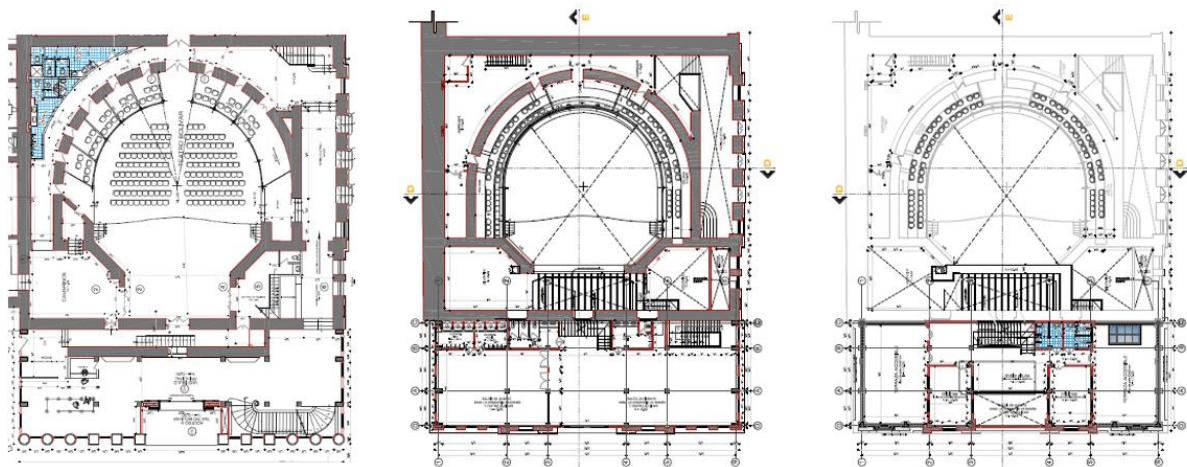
Teatro Universitario Bolívar, planta baja, primera y segunda planta alta
